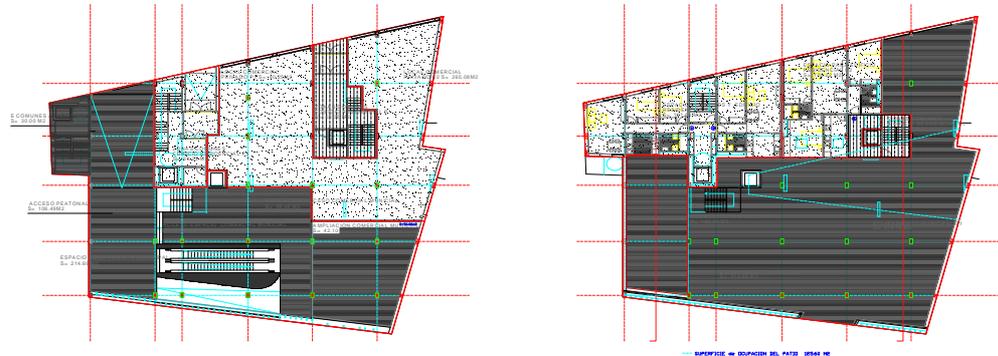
DISTRIBUCIÓN DE LAS PLANTAS BAJA Y PRIMERA SOBRE RASANTE.
